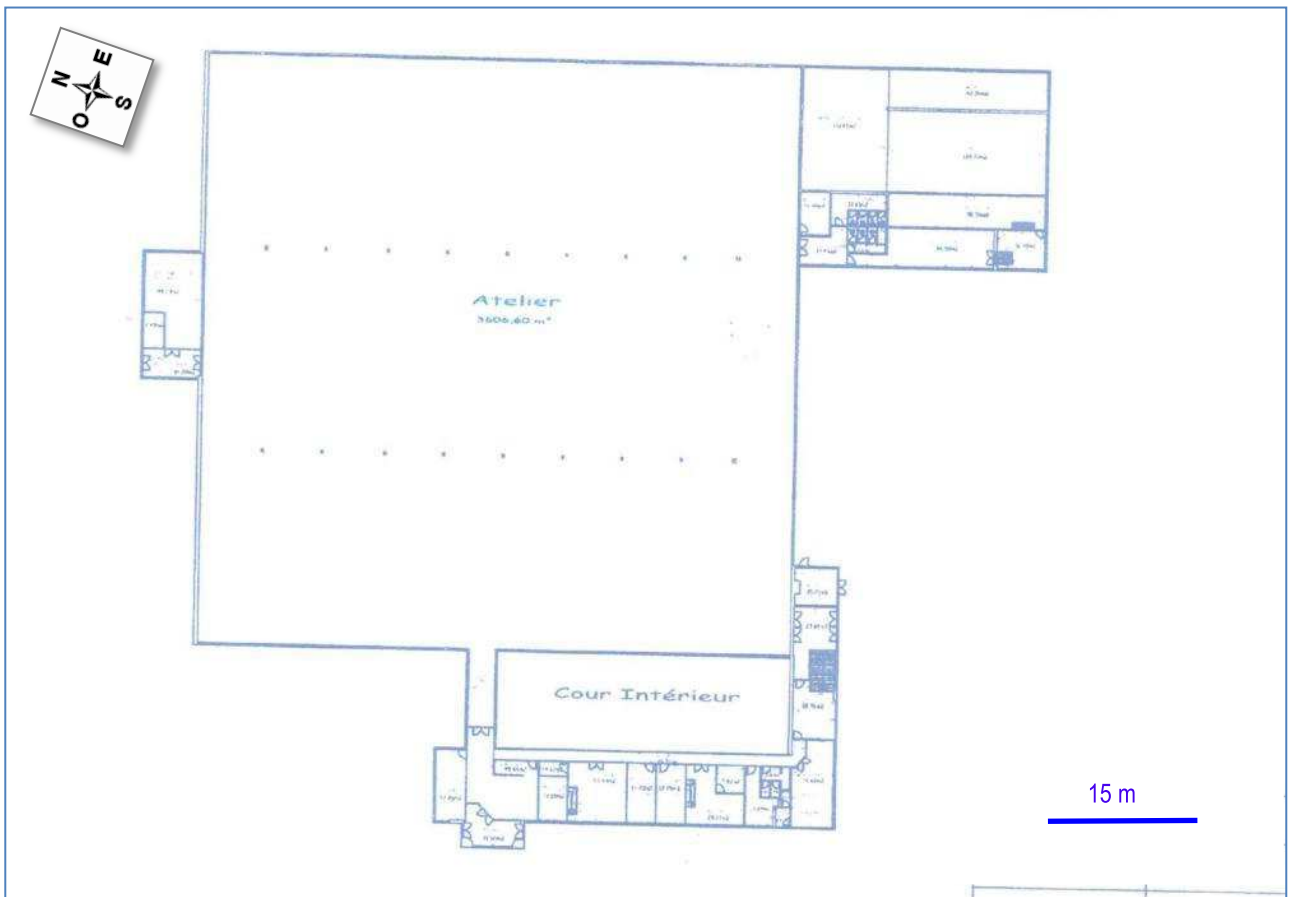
Plan du bâtiment du site actuel en RdC (Source : APTAR PHARMA)
